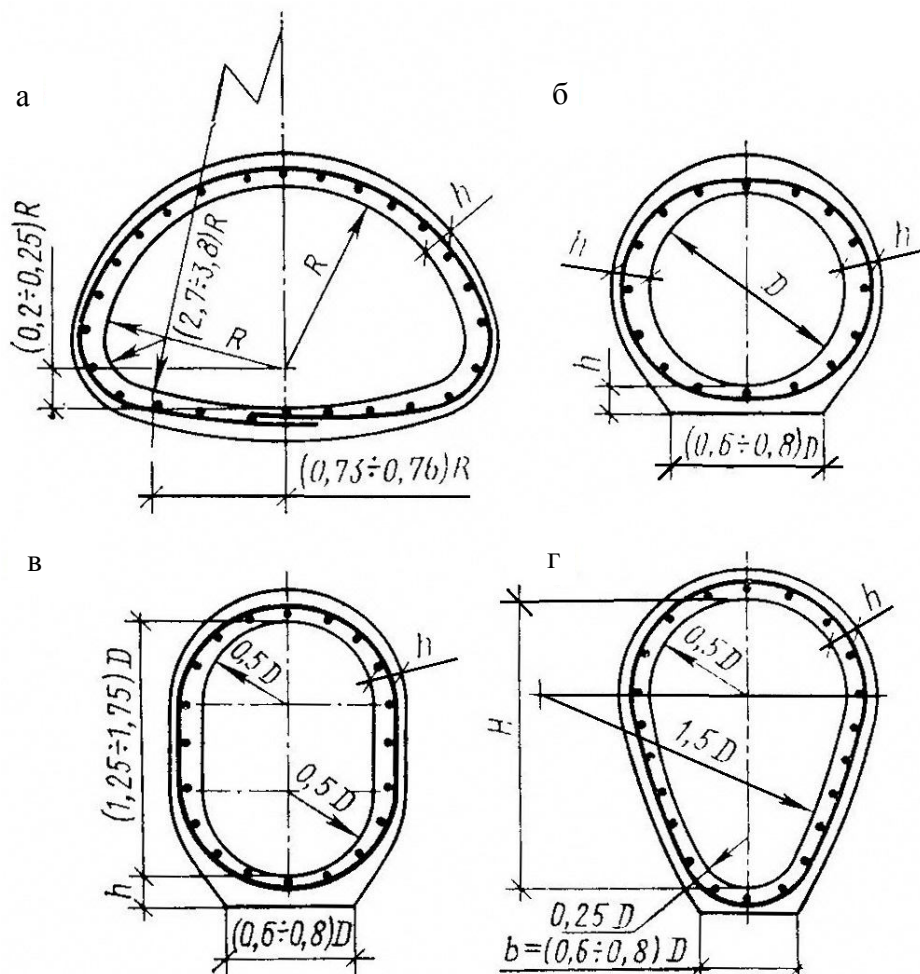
Армирование труб сложных поперечных сечений:
